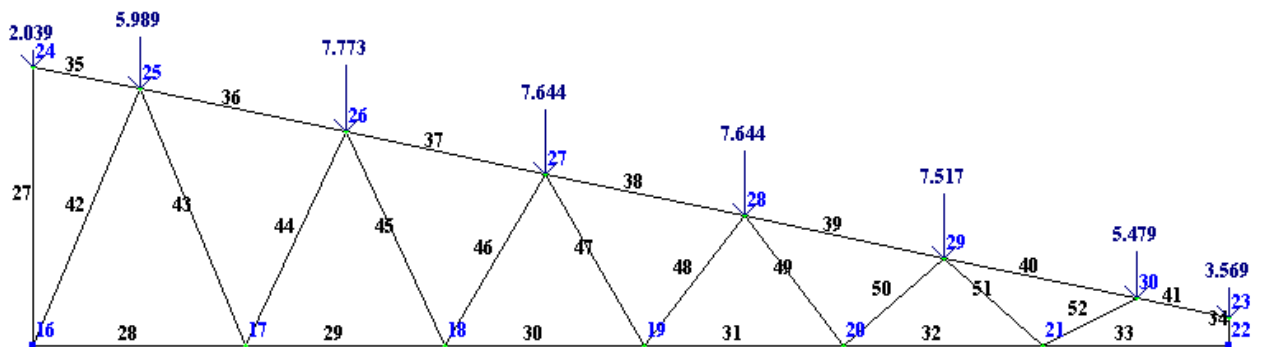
Схема загрузки фермы покрытия ФМ-1
